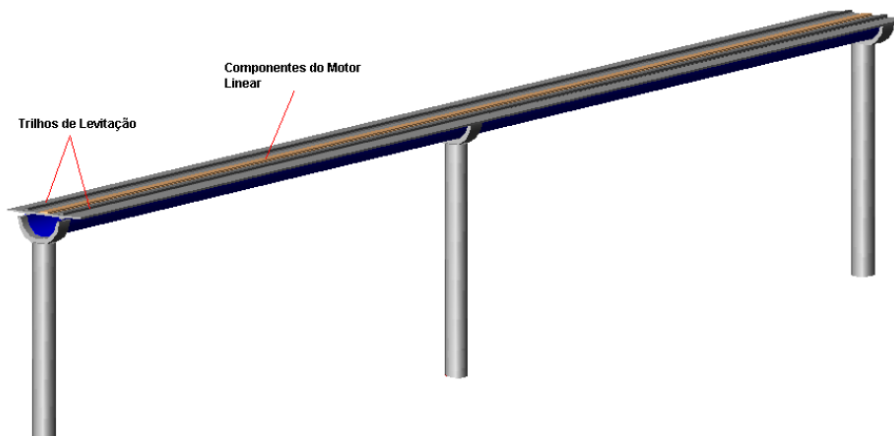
Projeção 3D da estrutura em via elevada para trens Maglev
